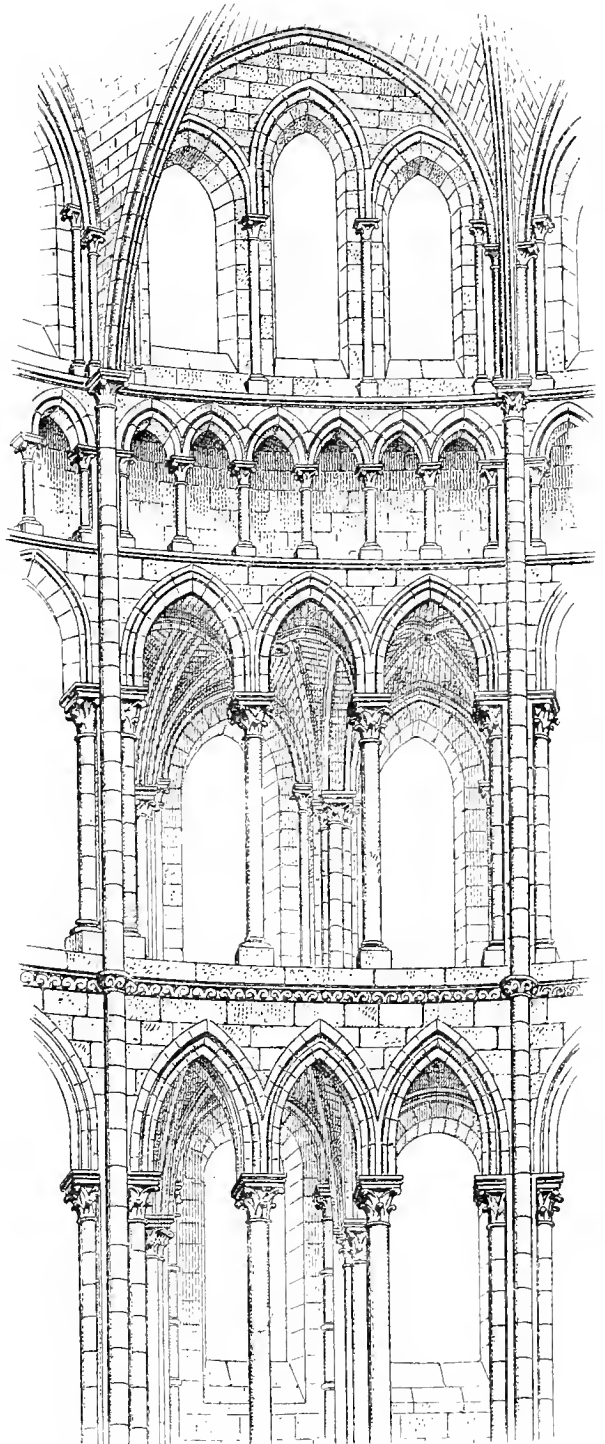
Croisillon sud arrondi de la cathédrale de Soissons (*Ann. archéol.*).
